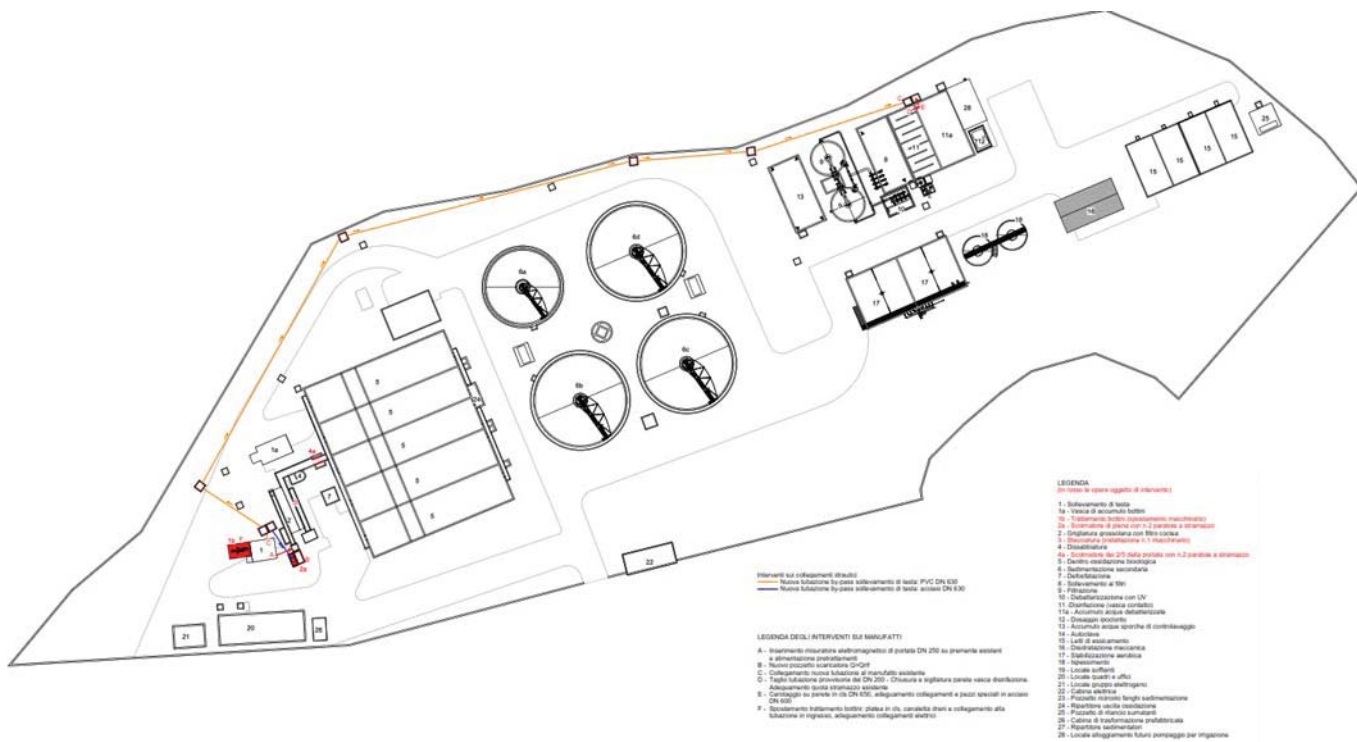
Planimetria di progetto, con indicata di rosso la nuova posizione stazione trattamento bottini
